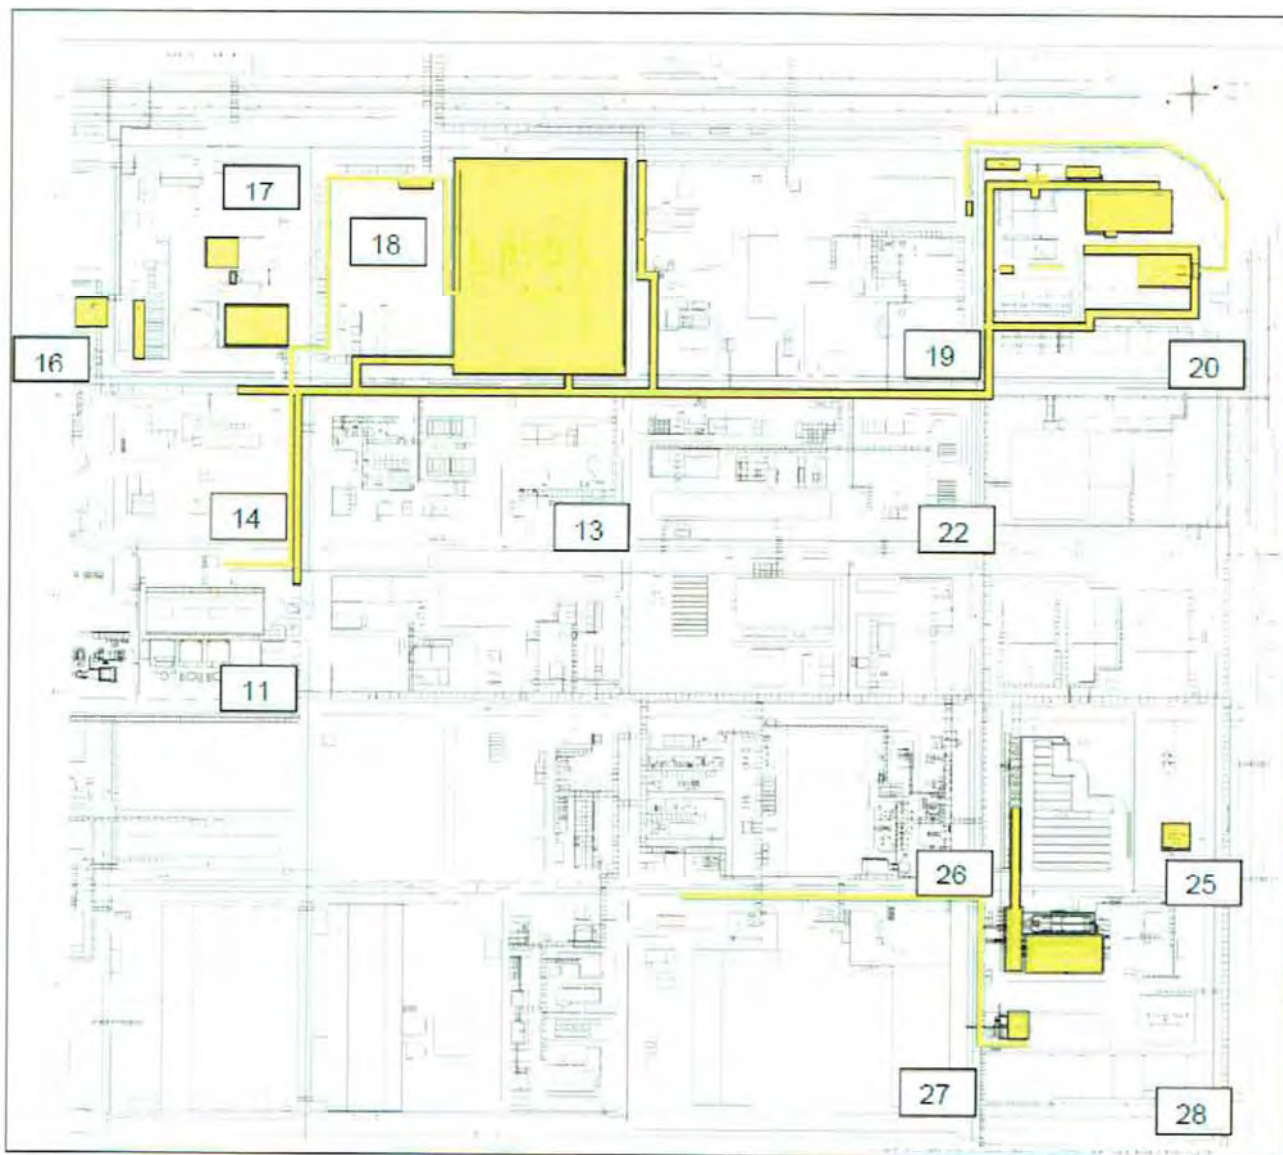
Stralcio della planimetria dell'Installazione con localizzazione degli interventi previsti per la realizzazione dell'impianto sSBR [cfr. pag 14 PIC ID 117/896]
